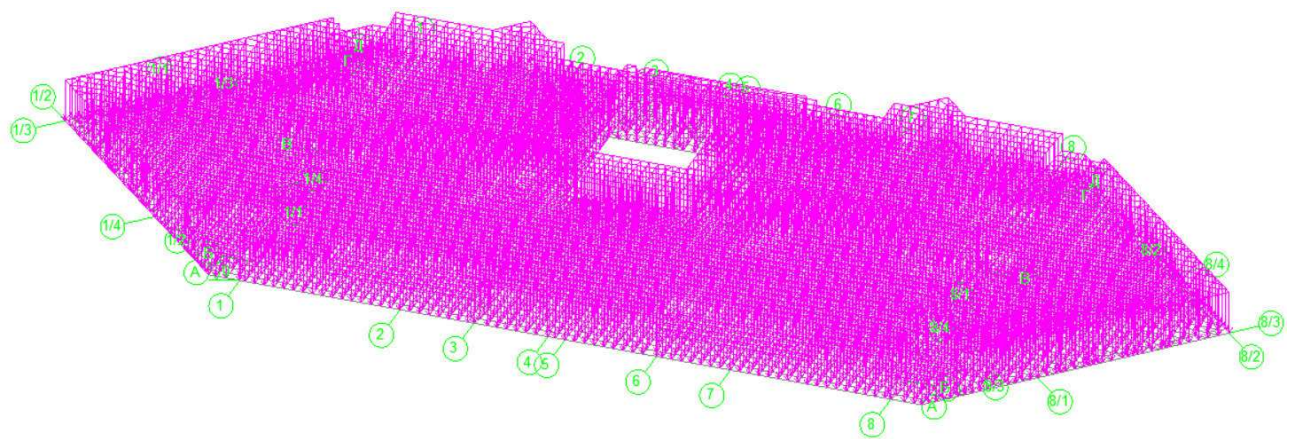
Загрузка плиты перекрытия весом пола
